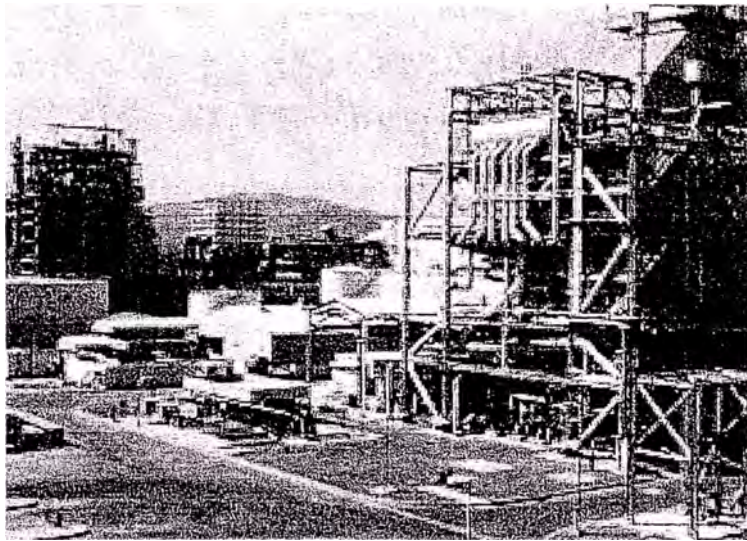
Planta de Sudamericana de Fibras (SdF)
